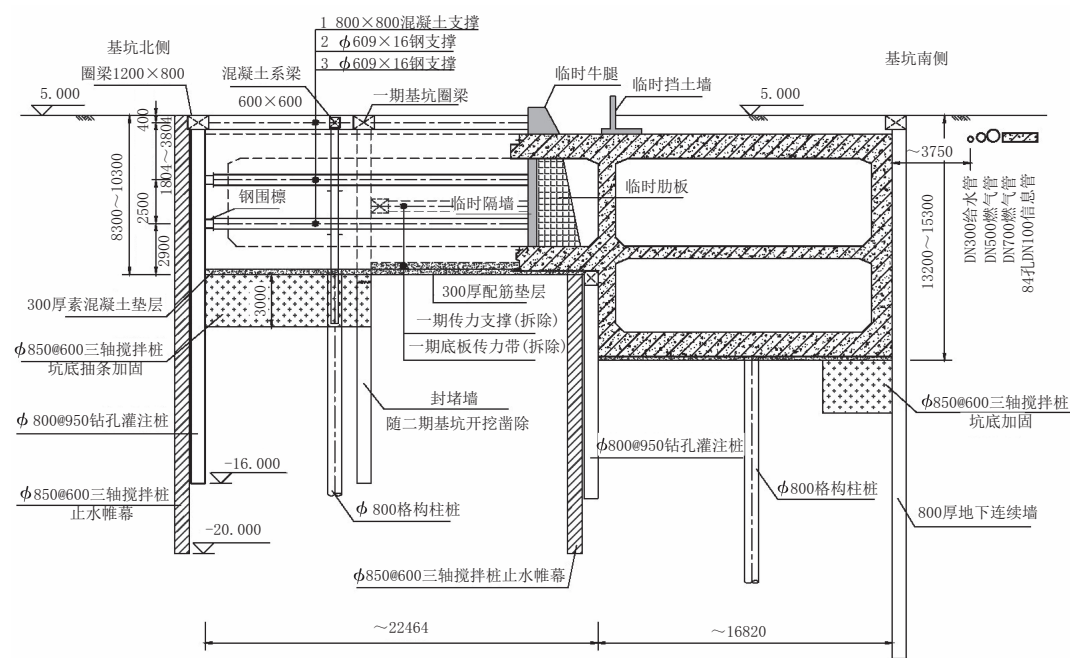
二期基坑典型横剖面(标高单位:m,尺寸单位:mm)
